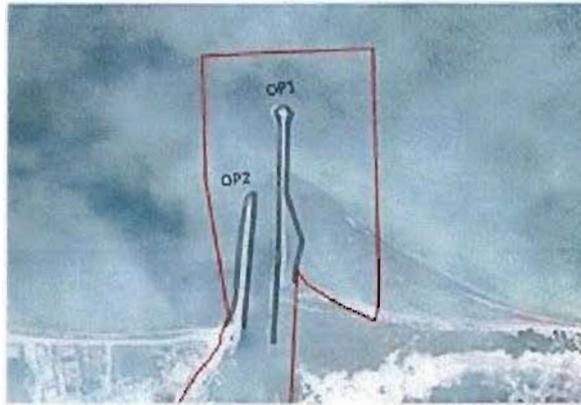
Obras de protección del Recinto Dzilam de Bravo.
